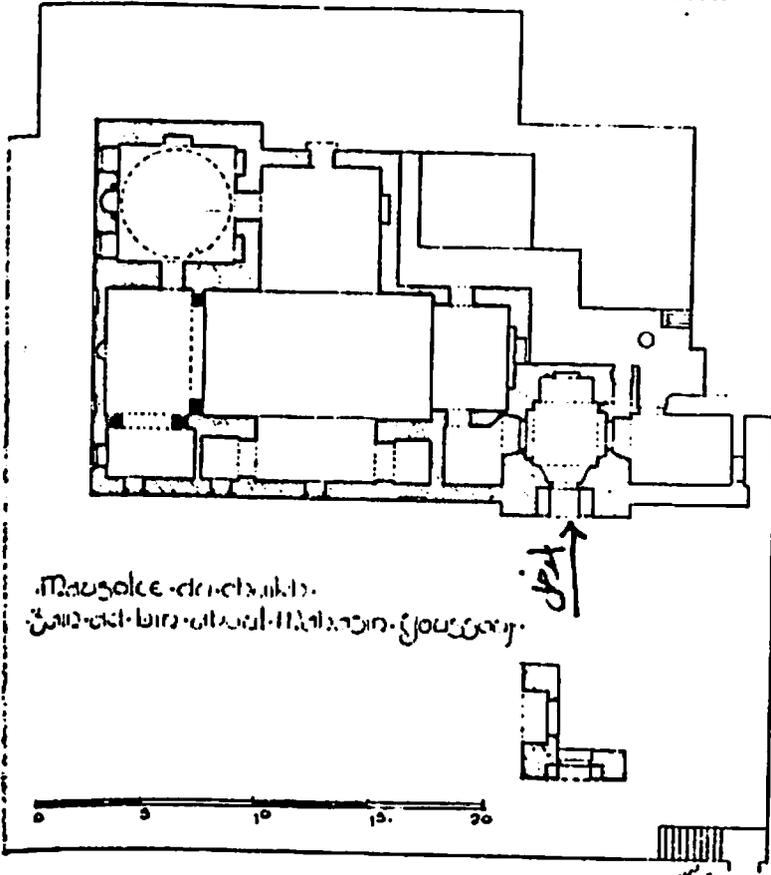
مسقط أفقي لقبة الأشراف خليل بن قلاوون بشارع الأشراف
